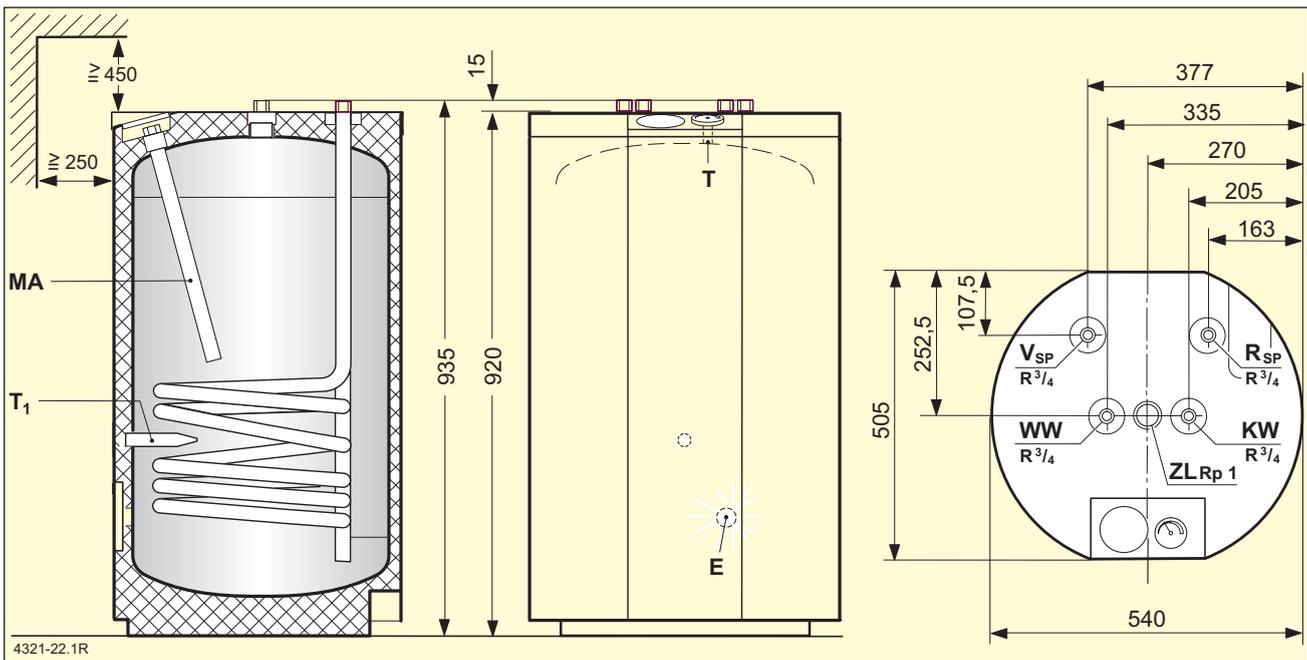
Bau- und Anschlussmaße ST 120-1 Z
